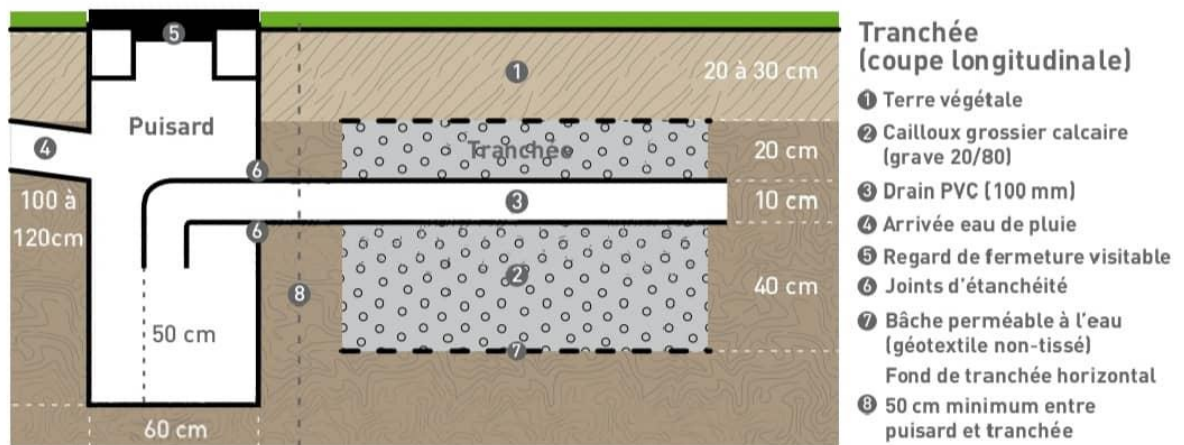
schéma de drainage des eaux pluviales : coupe longitudinale d'une tranchée drainante (<https://www.cerema.fr>)
